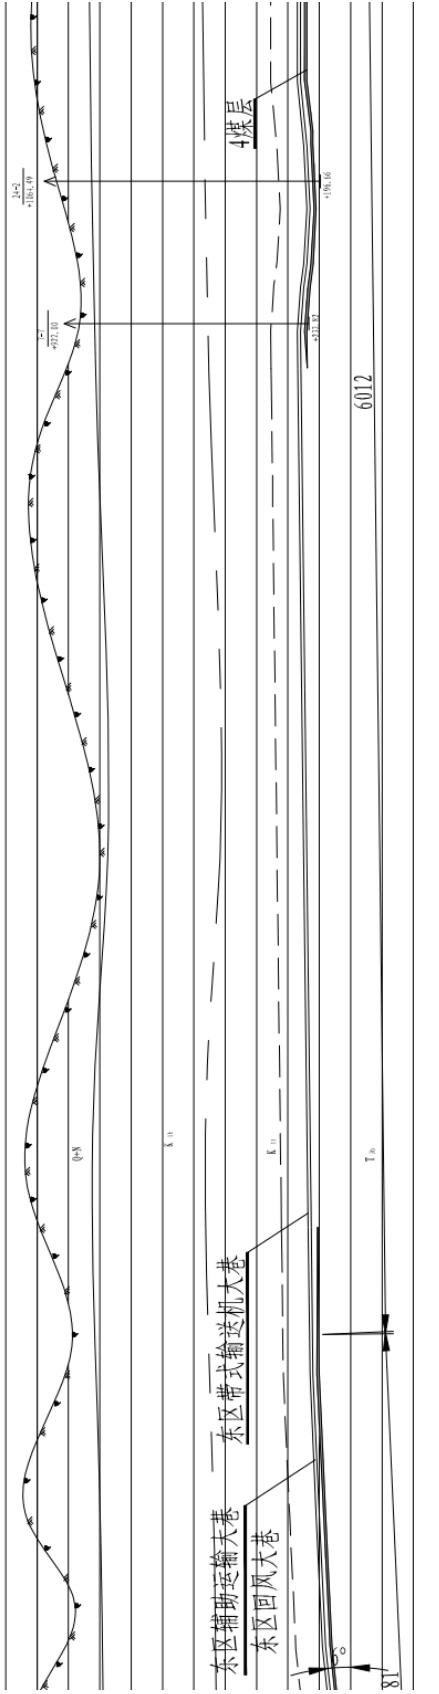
缫矿井开拓方式 I-I 剖面图 (4-3)
